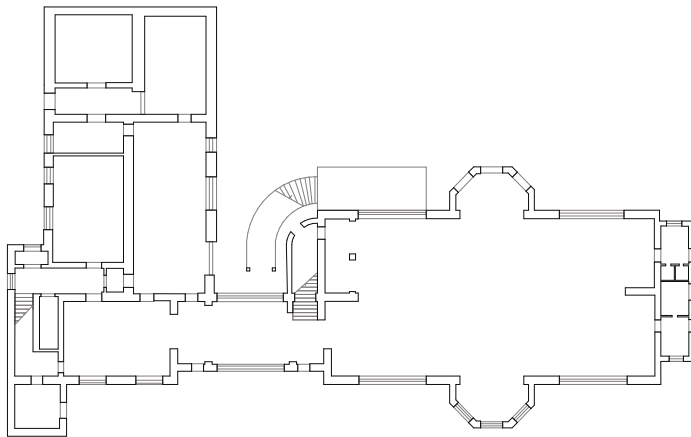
1 Grundriss Volksrestaurant
